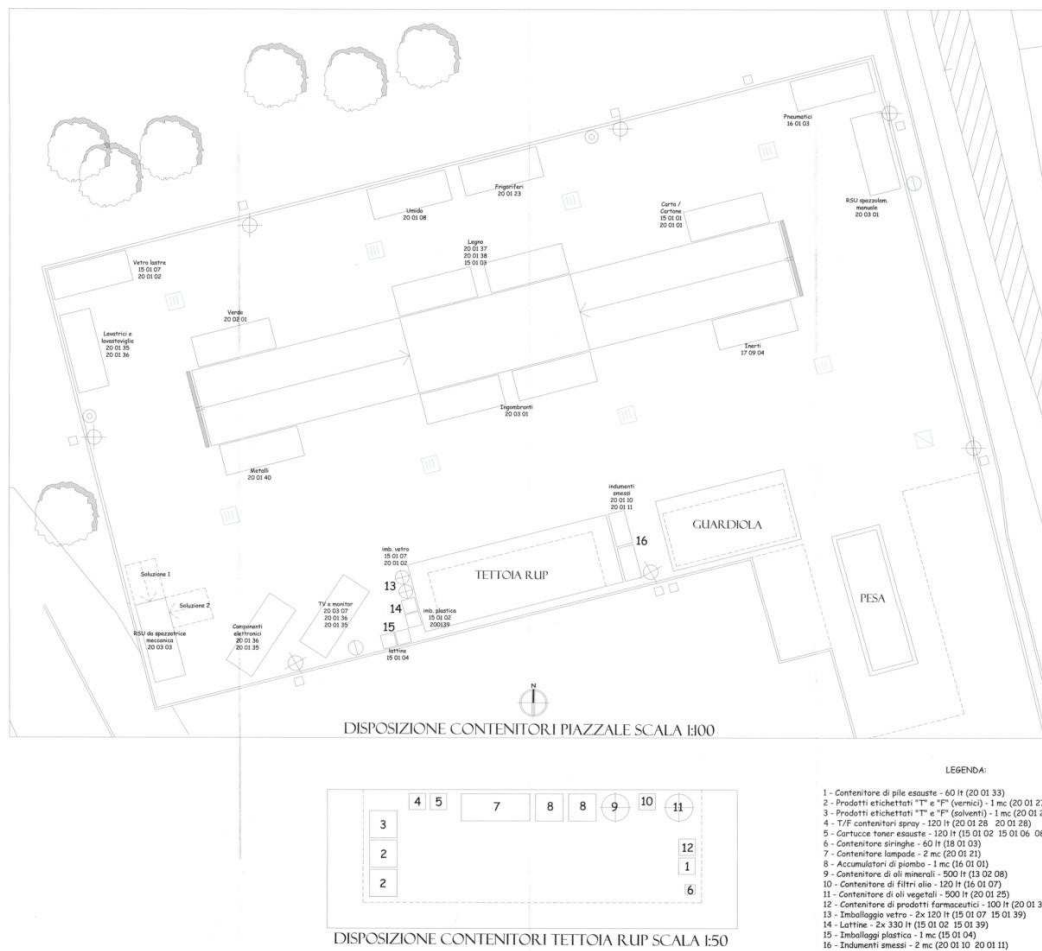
Stralcio planimetria con disposizione cassoni esistenti
